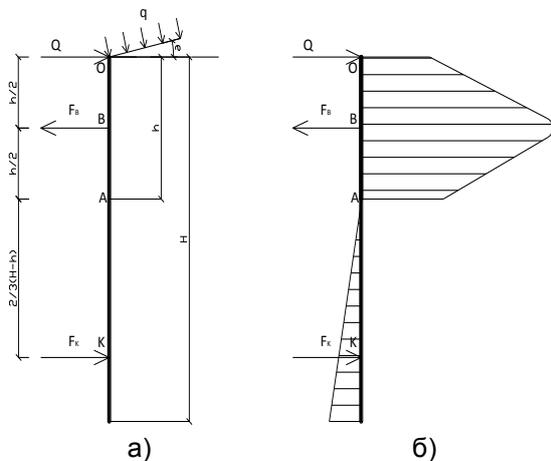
Схема для расчета сваи при действии на нее горизонтальной нагрузки в классическом полупространстве Ренкина (а) и напряженное состояние грунта на стволе сваи при работе по этой схеме (б)
